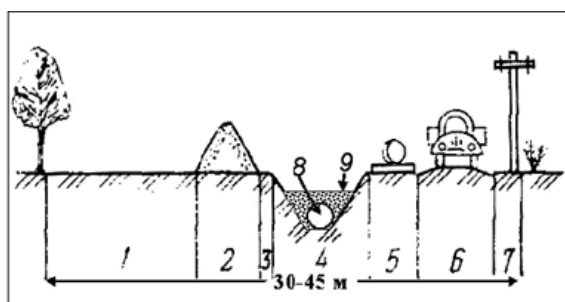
Полоса отвода земель под строительство одного трубопровода [55]: 1 – полоса для работы бульдозера при засыпке траншеи; 2 – отвал; 3 – бровка; 4 – траншея; 5 – полоса для сборки и сварки труб; 6 – грунтовая дорога; 7 – линия связи; 8 – труба; 9 – грунт обратной засыпки
